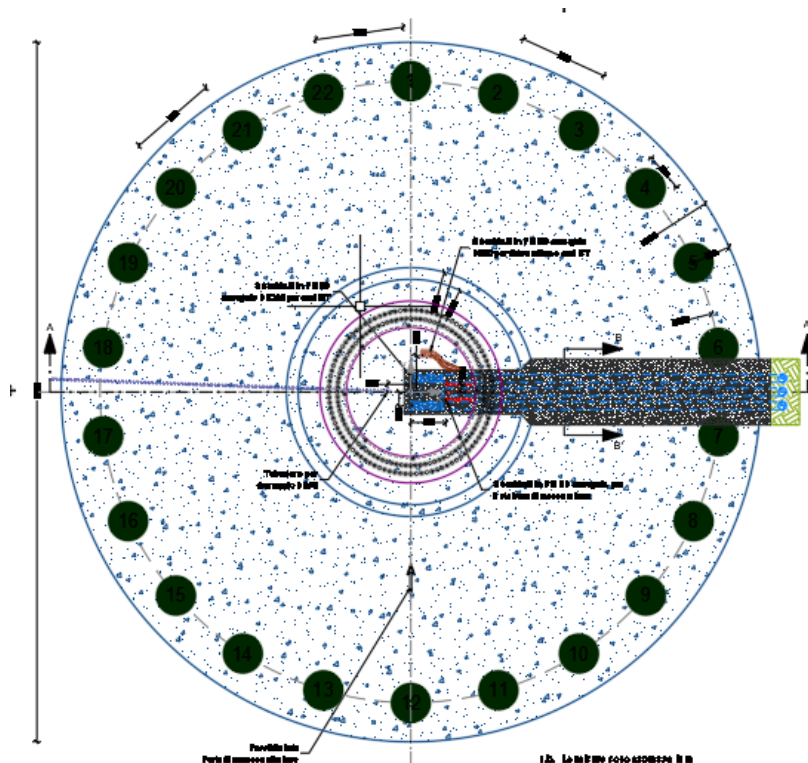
Pianta del plinto con indicazione dei pali di fondazione (n.22 del diametro 100 cm)
